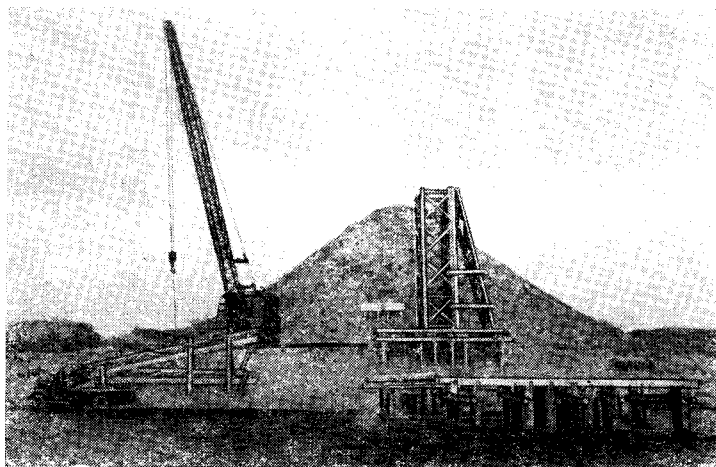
Монтаж деревянной блочной опоры высотой 12 м краном К-104 с удлиненной стрелой
